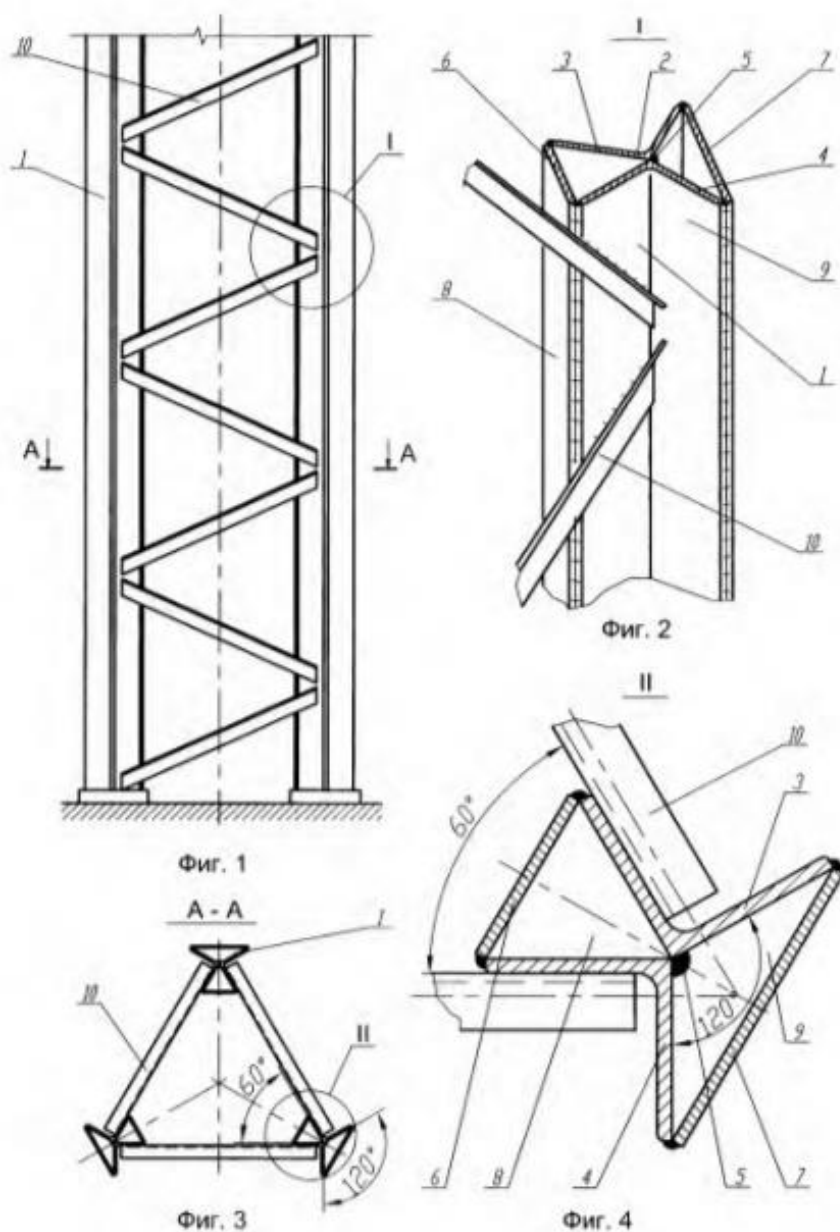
Трехгранная решетчатая опора. 1- пояс; 2 – стойка; 3,4 – углы; 5 – соединения сварки; 6,7 – стальные полосы; 8,9 – трехгранные конструкции; 10 – стержни решетки
